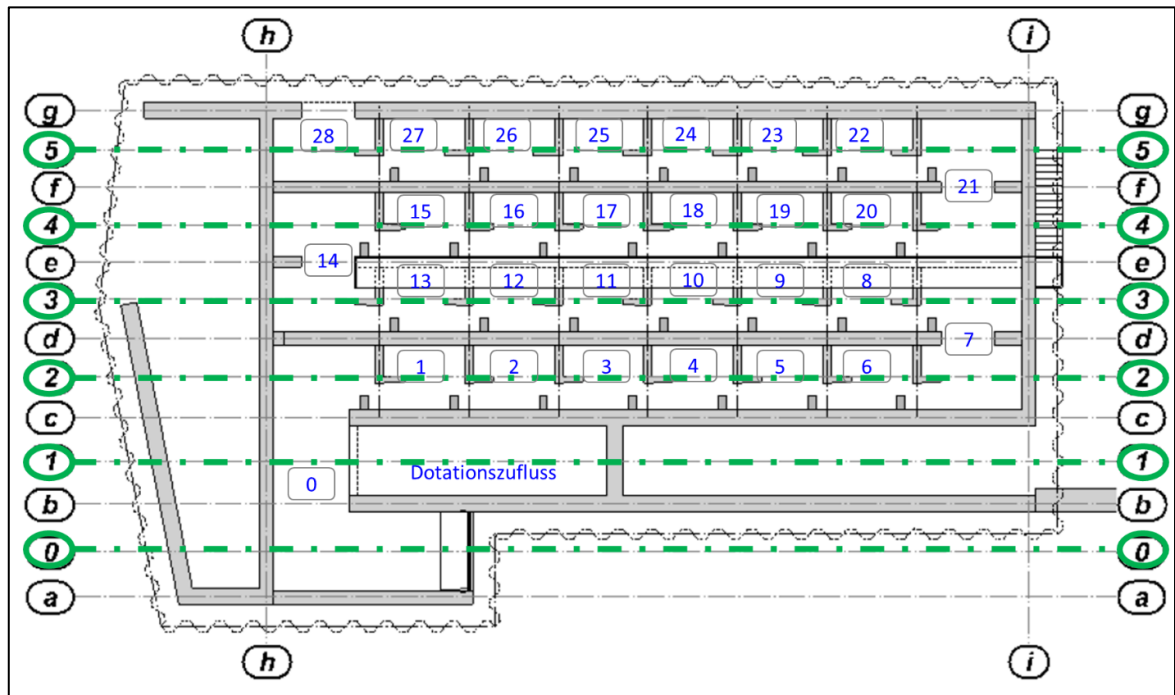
Grundriss Einstiegsbauwerk – Achseneinteilung
